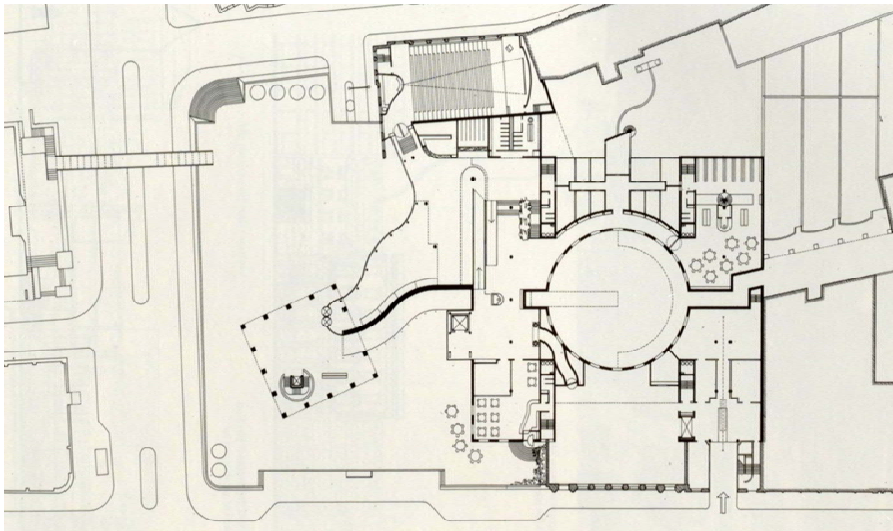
James Stirling and Partner „Landesgalerie Nordrhein-Westfalen in Düsseldorf“, 1975; Grundriss Eingangsgeschoss;
